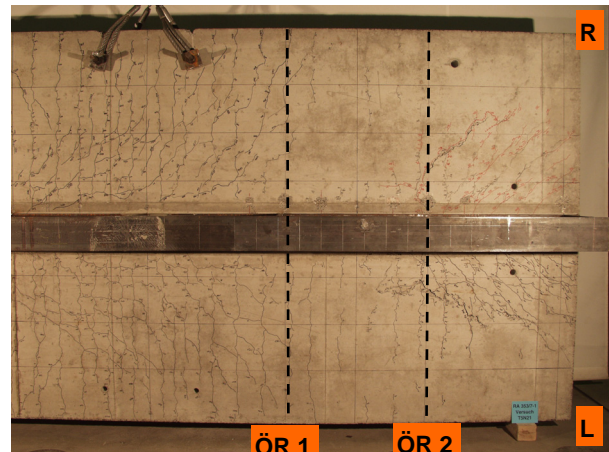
Rissbild auf der Betongurtunterseite
